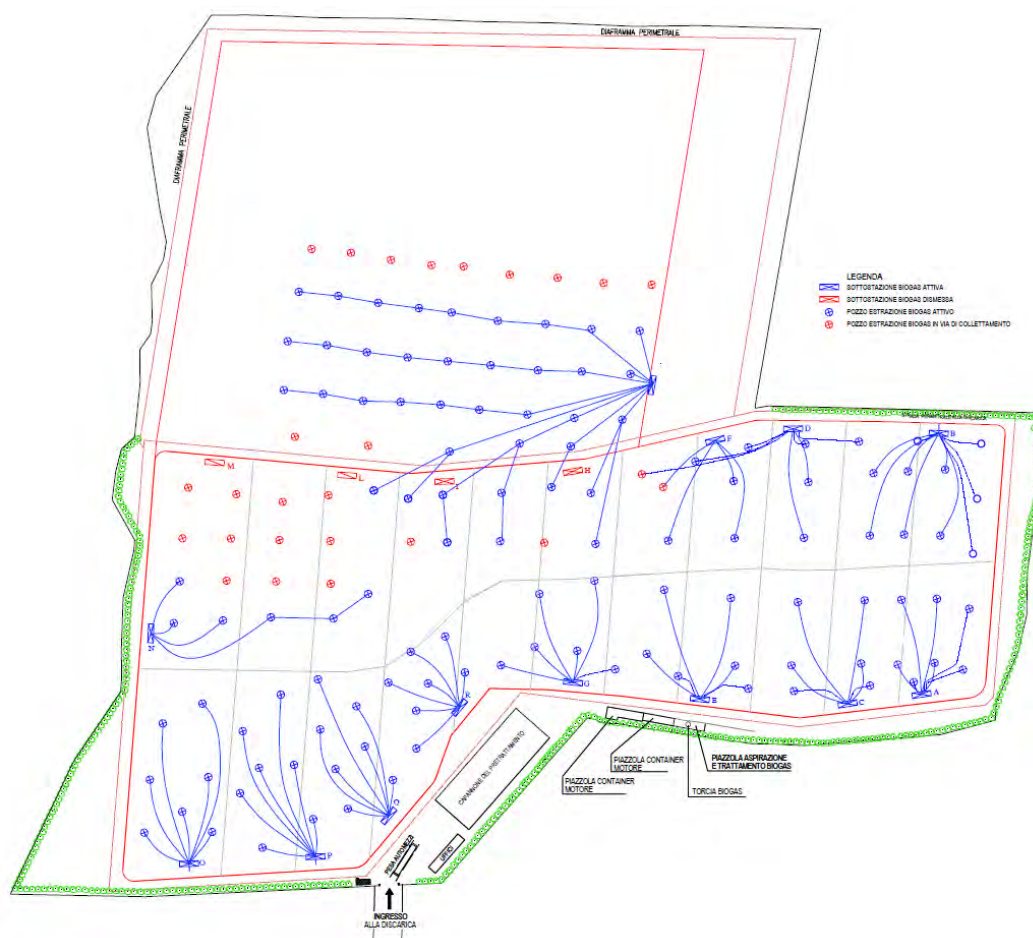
Planimetria stato di fatto impianto di captazione biogas al 30/12/2018
